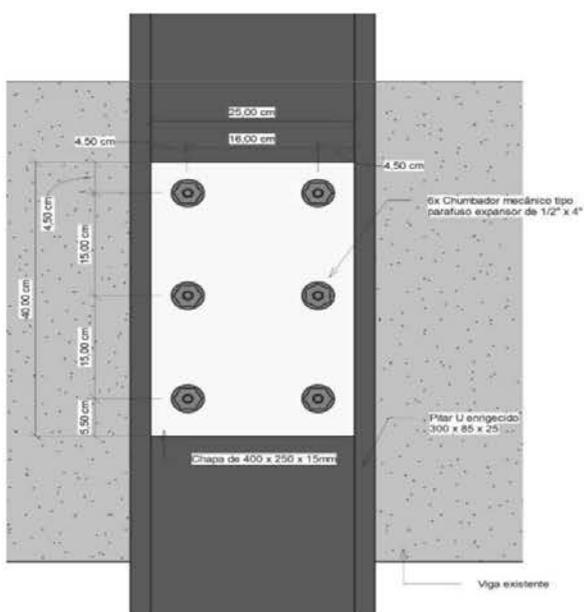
Detalhe fixação do pilar nas vigas dos pavimentos superiores
